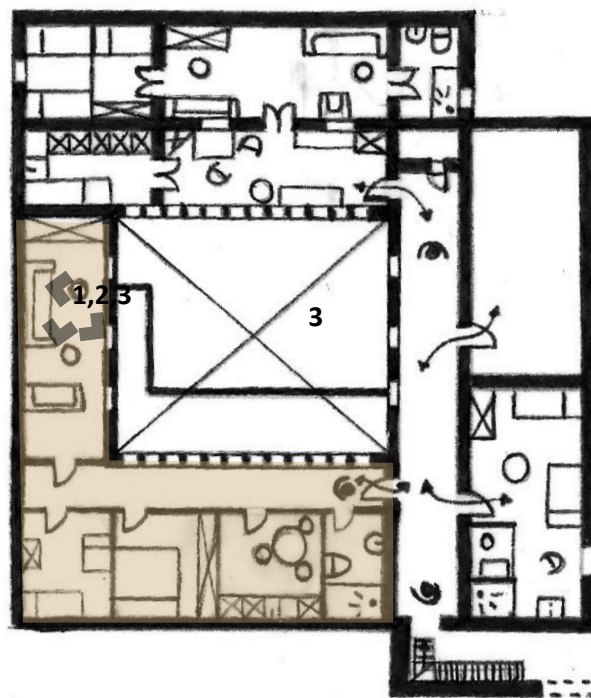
Croquis du plan du 1er étage, maison oukalisée 2
